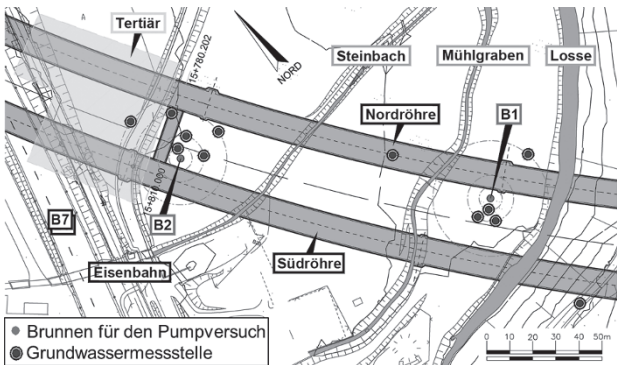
Lageplan der Brunnen und Grundwassermessstellen
